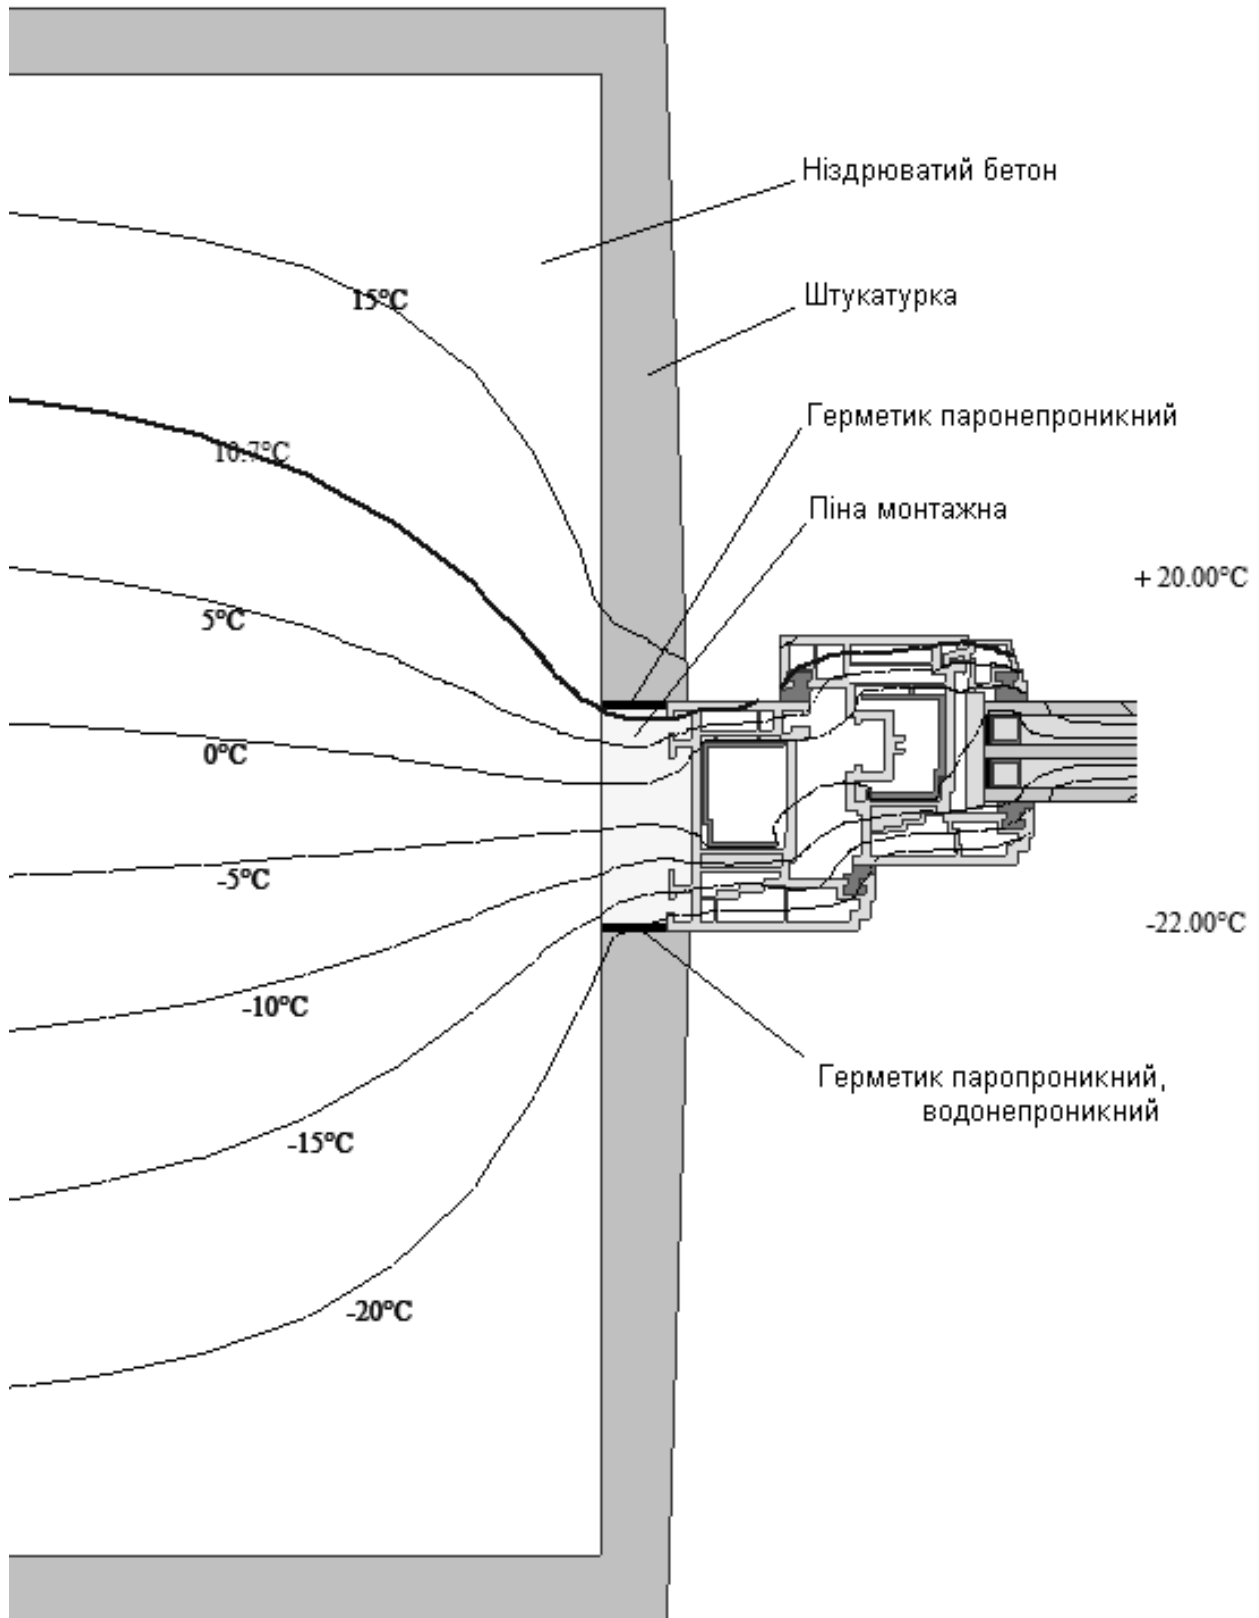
Узел бокового примыкания оконного блока из ПВХ профилей к стеновому проему без четверти к стене из ячеистого бетона толщиной 450 мм
